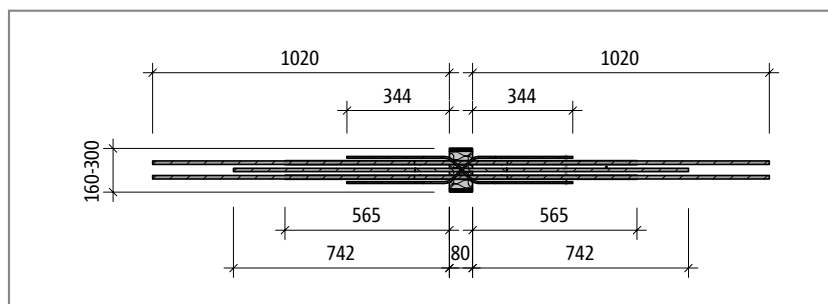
Schöck Isokorb® T Type W-M4 : Plan de base du produit
